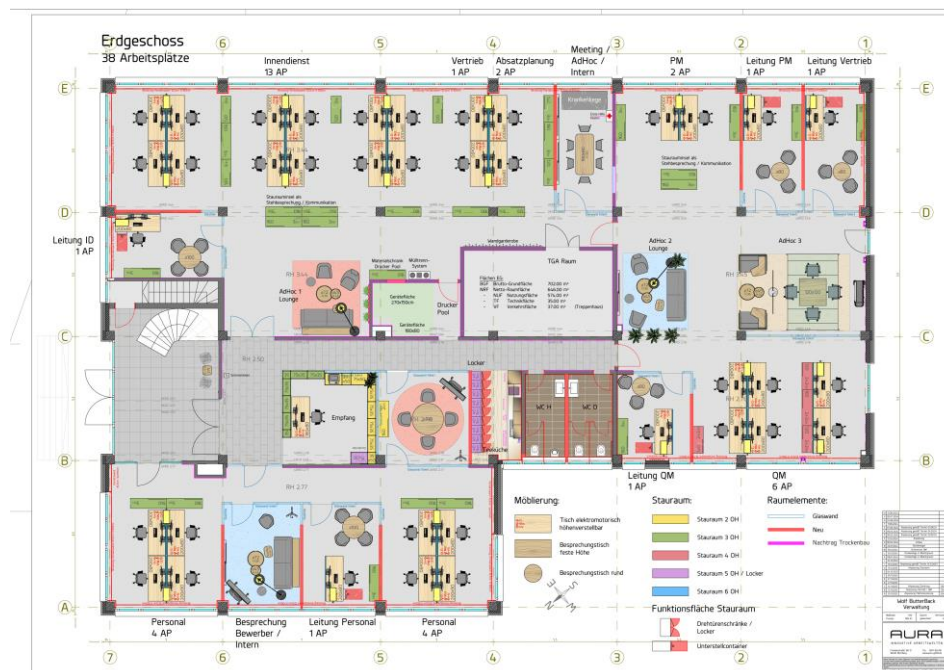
Grundriss aus einem Planungsprojekt der Aura (Aura GmbH)
